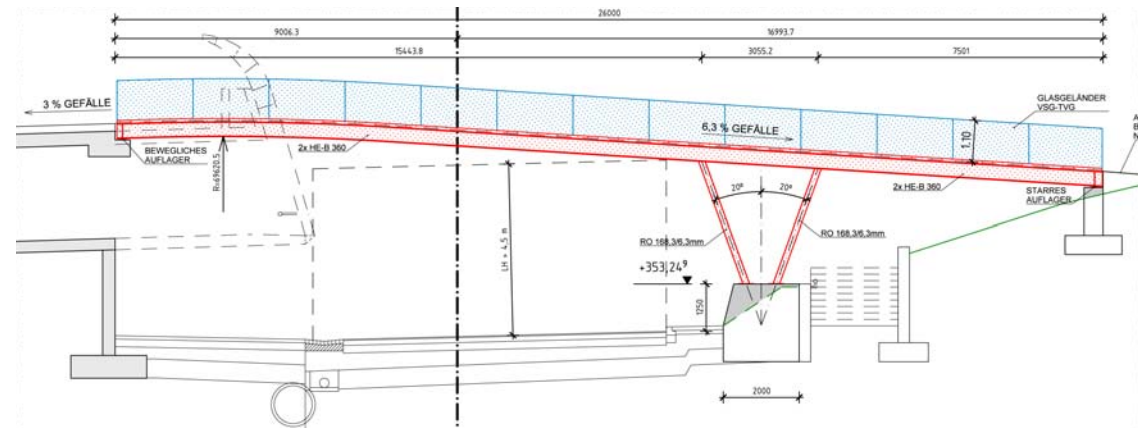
(v.r.o. im UZ) Grundrissausschnitt Fußgängerbrücke o.M.
